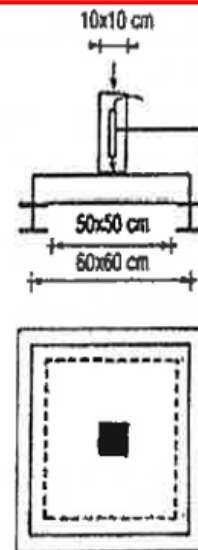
Essai de poinçonnement-flexion sur dalle.
